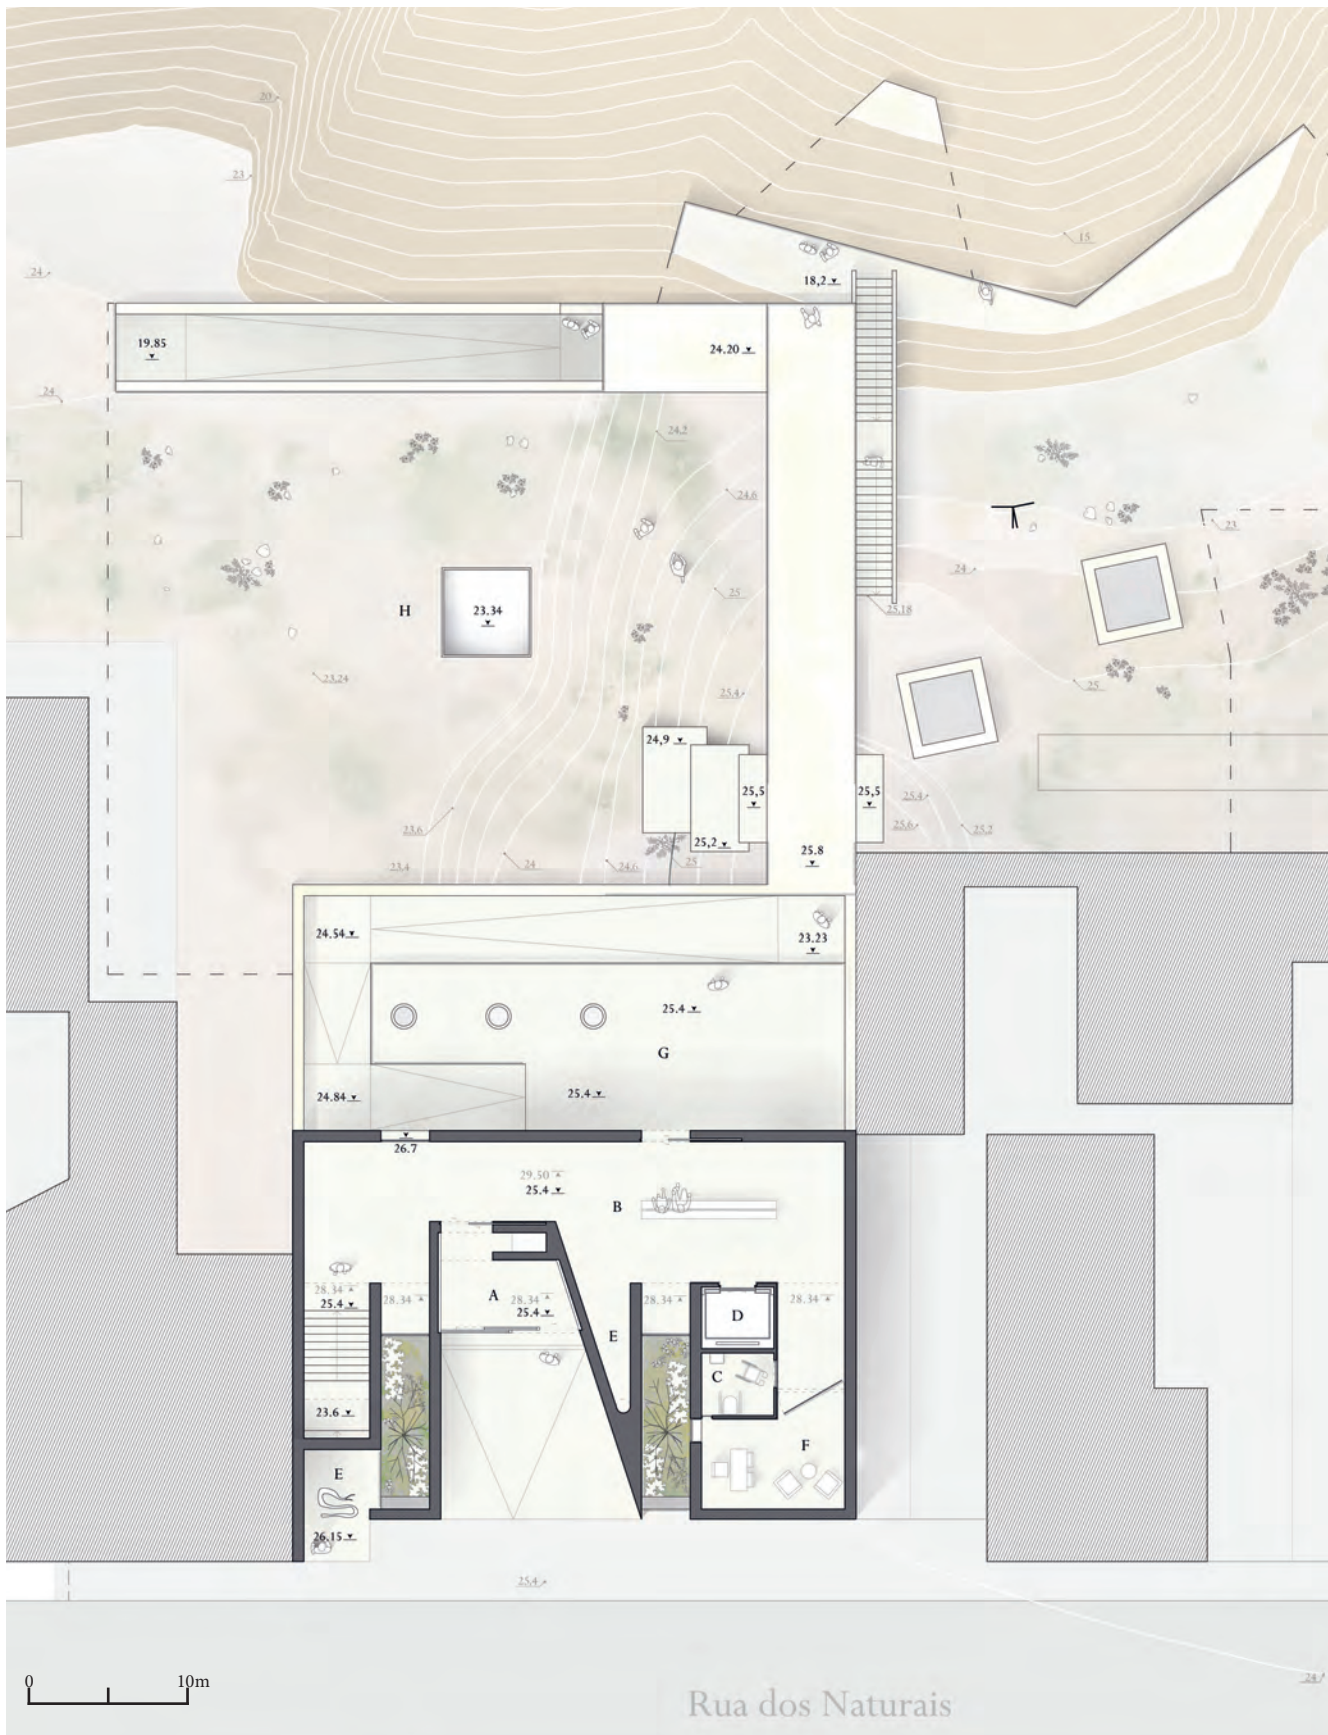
PROPOSTA - Planta de piso 1, nível 26 (legenda em anexo).
